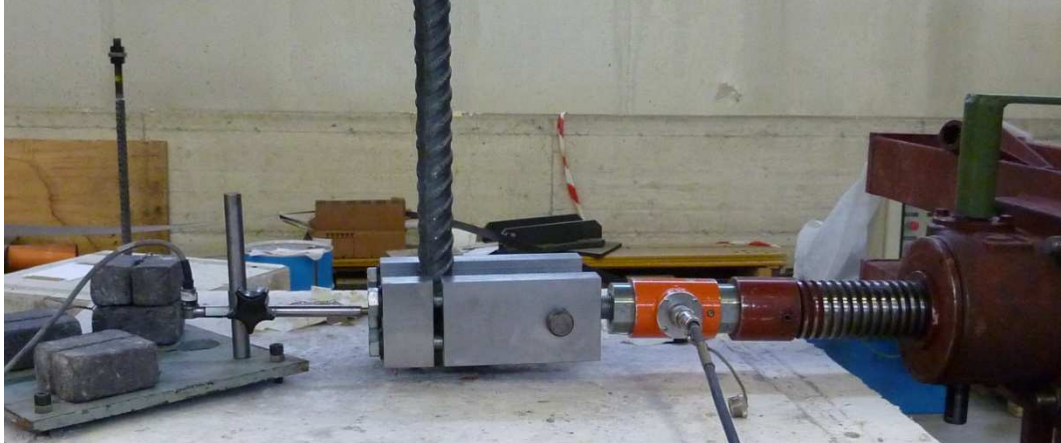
LVDT applicato all'elemento d'acciaio montato sulla barra.
